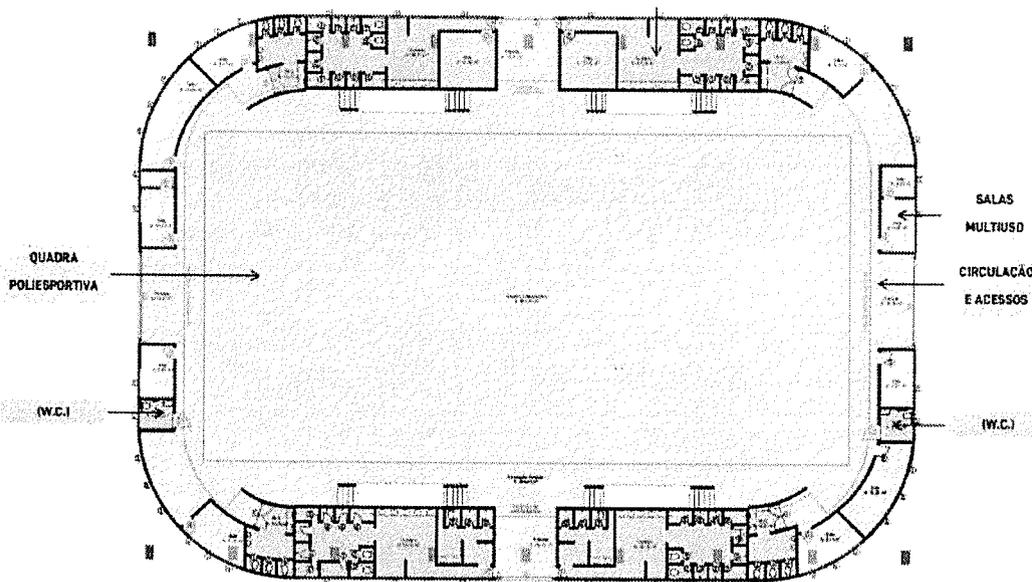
Planta com setorização do pavimento térreo. Sem escala
